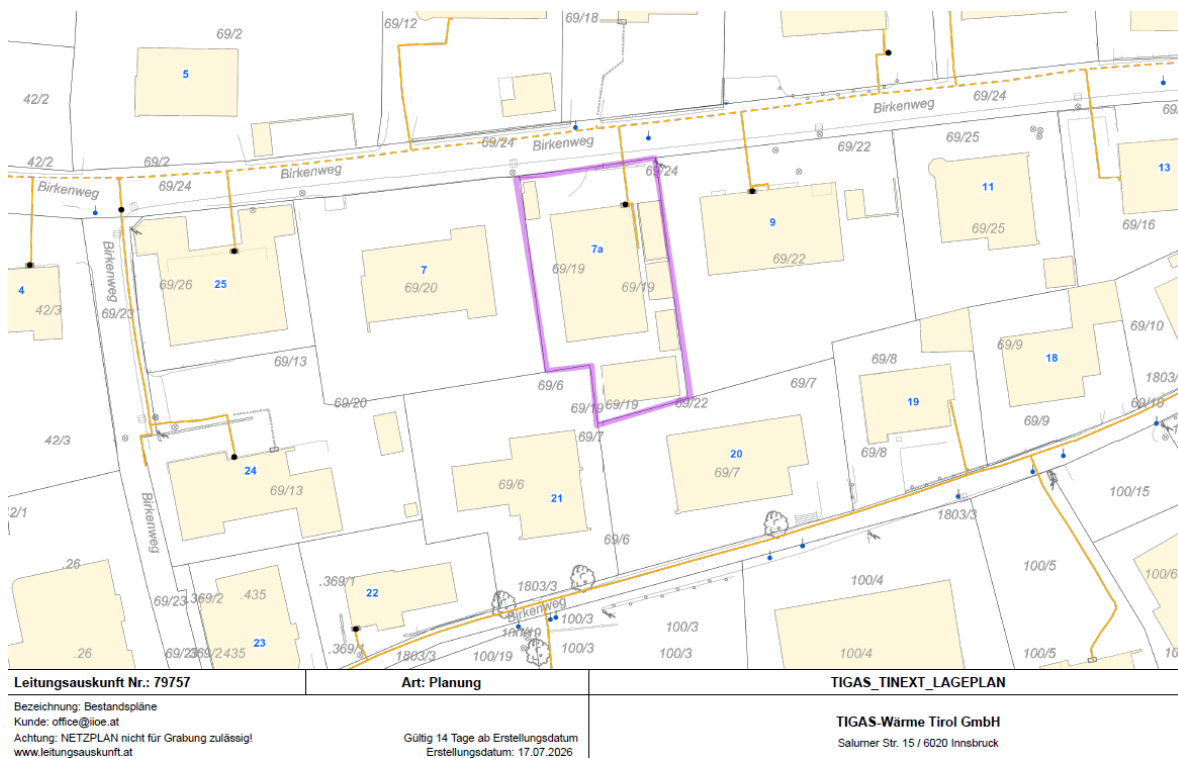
Leitungslageplan. TIGAS (v. 17.07.2026)
